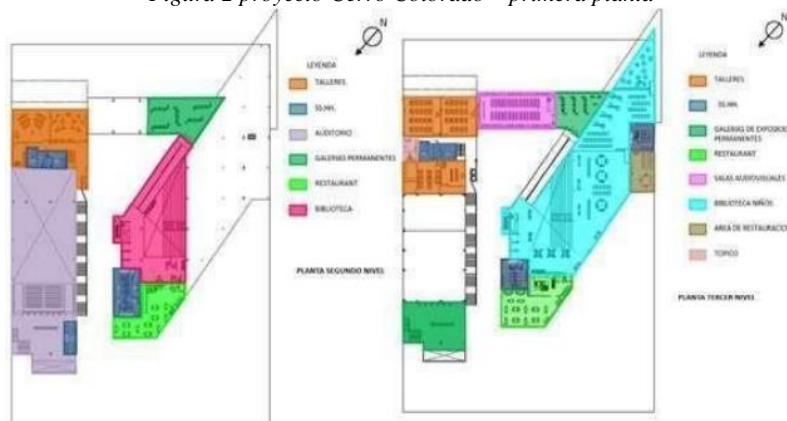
Proyecto Cerro Colorado – segunda y tercera planta
